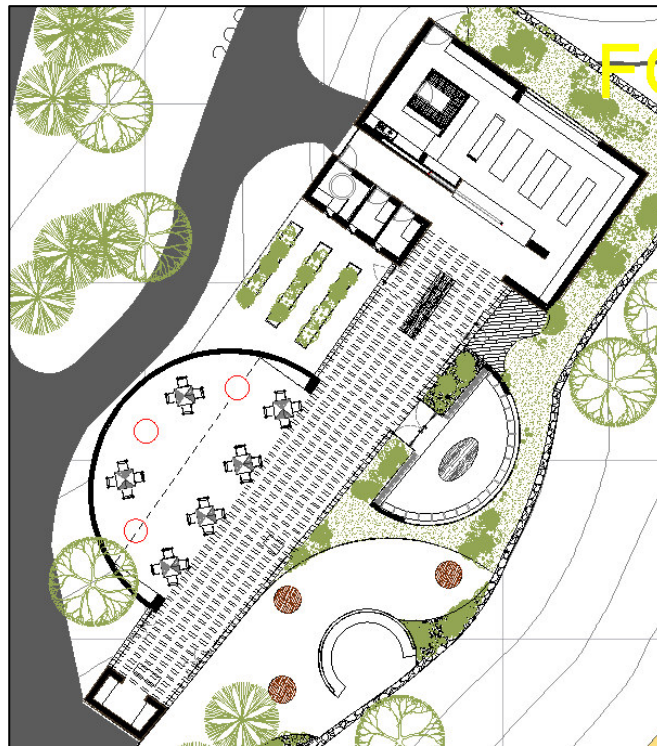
Vista superior del Restaurante “formal” Adán Paredes (Master Plan)
